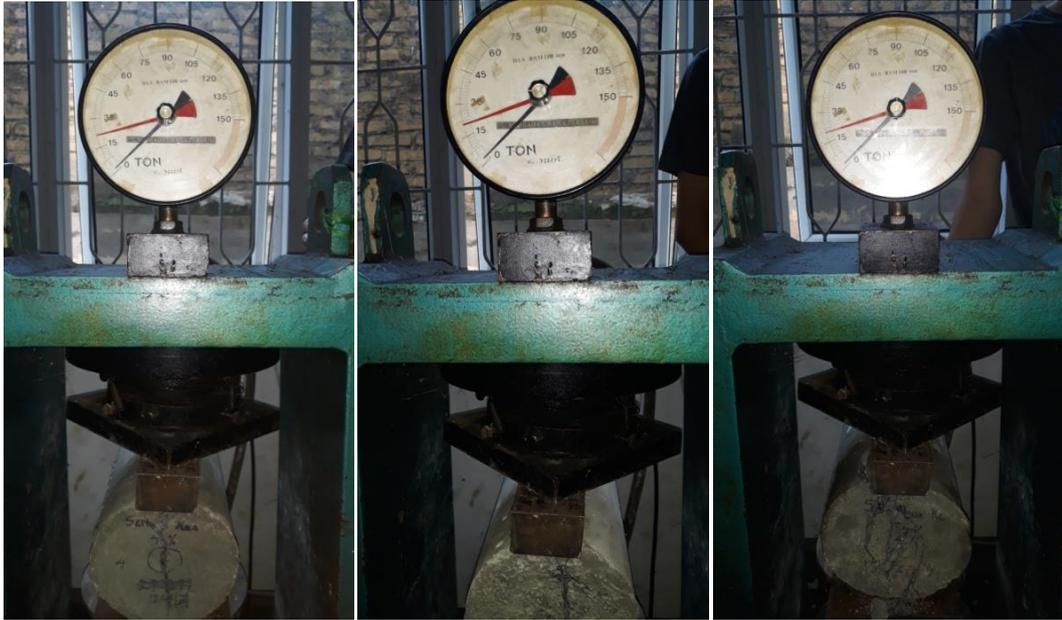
Beton serbuk kaca 6% dan bondcrete 2% (BK-6)
